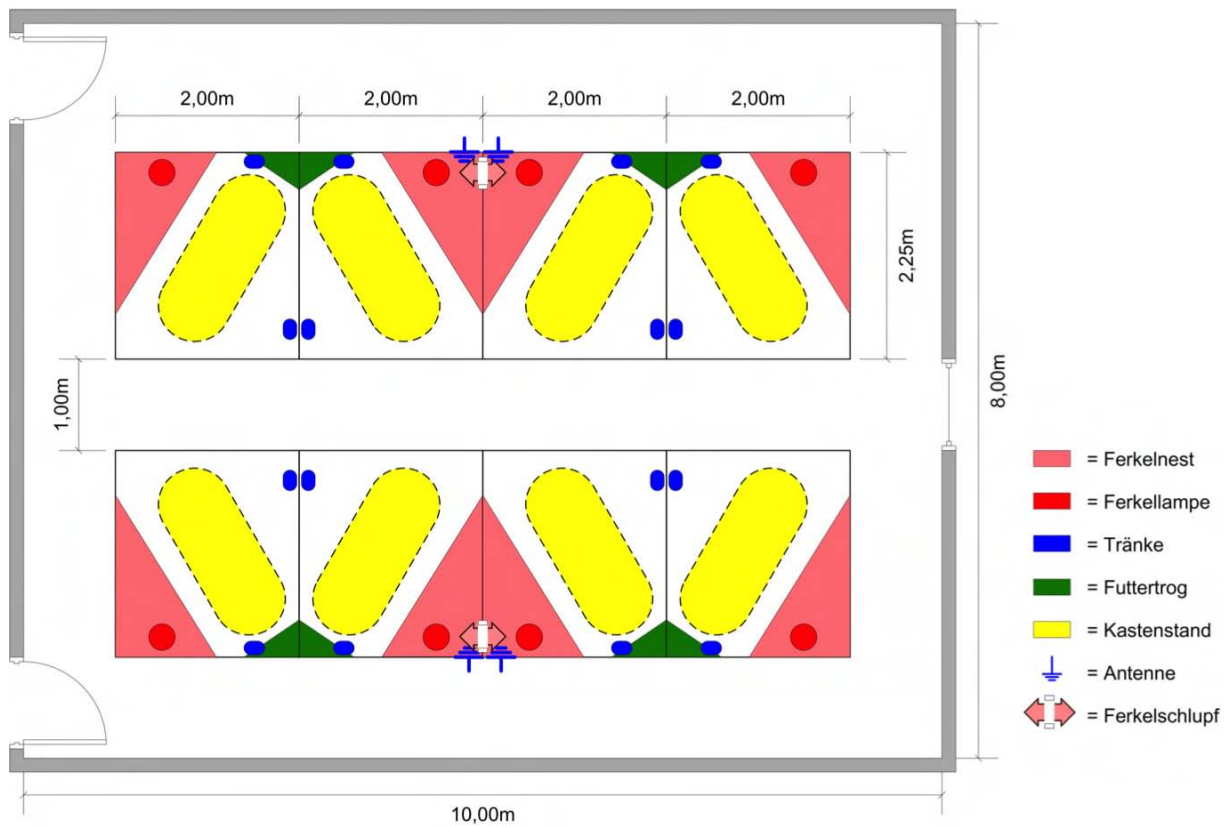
Grundriss von Stall 5, Abteil mit Kastenständen
